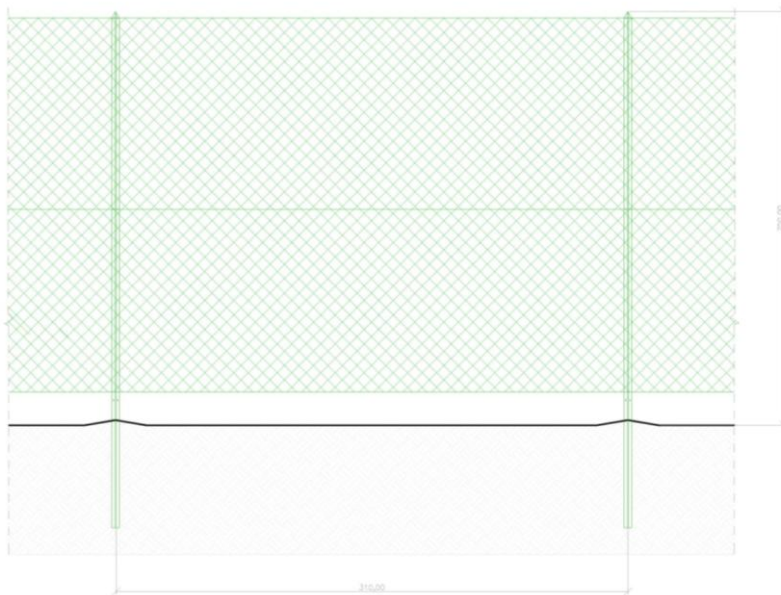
Prospetto tipo recinzione perimetrale con apertura inferiore (20-30 cm) per il passaggio della piccola fauna.
